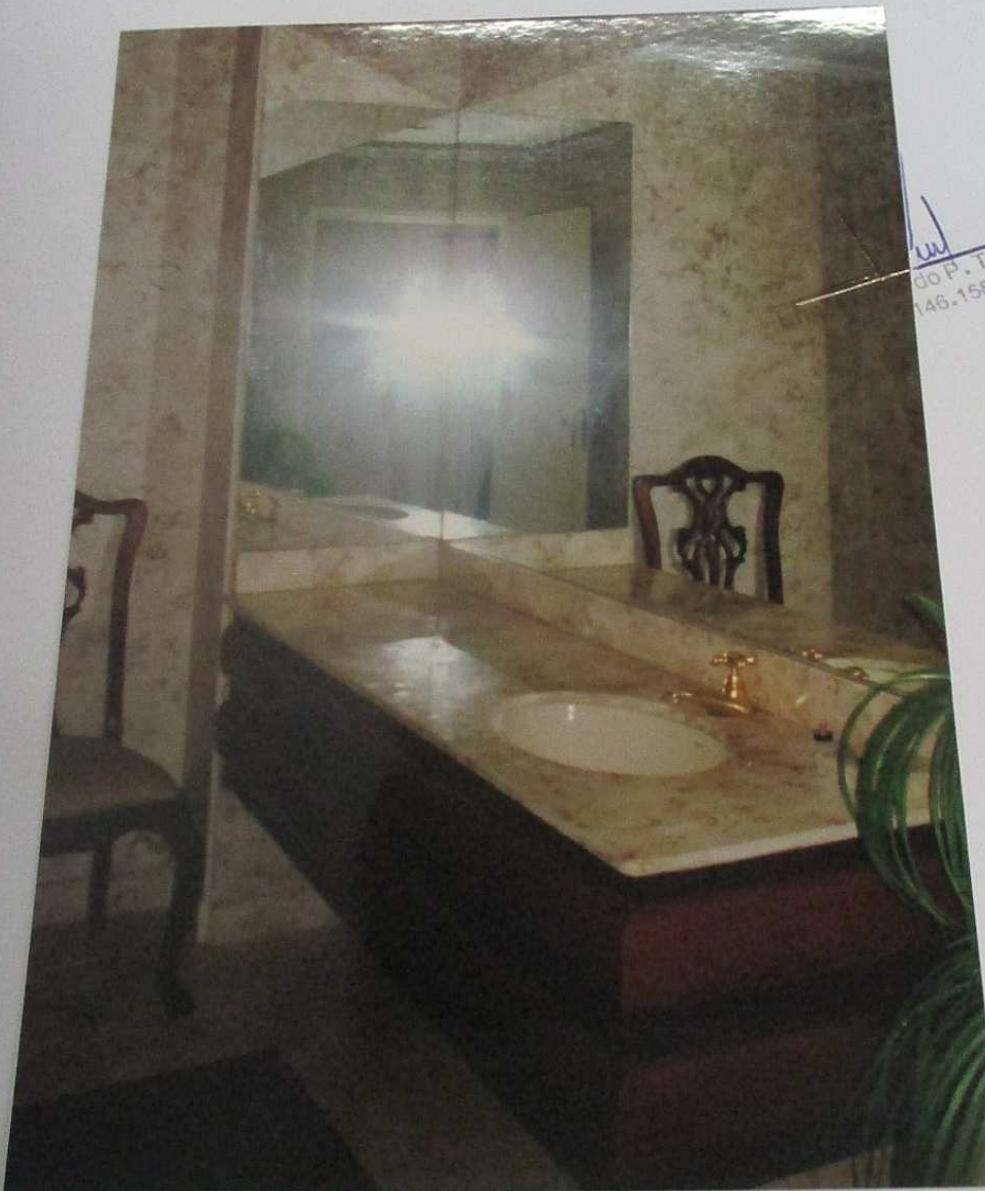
Vista parcial do lavabo; o piso e as paredes são revestidas com mármore "travertino", o fôrro com rebaixo de gesso e o vão com vidro temperado.
